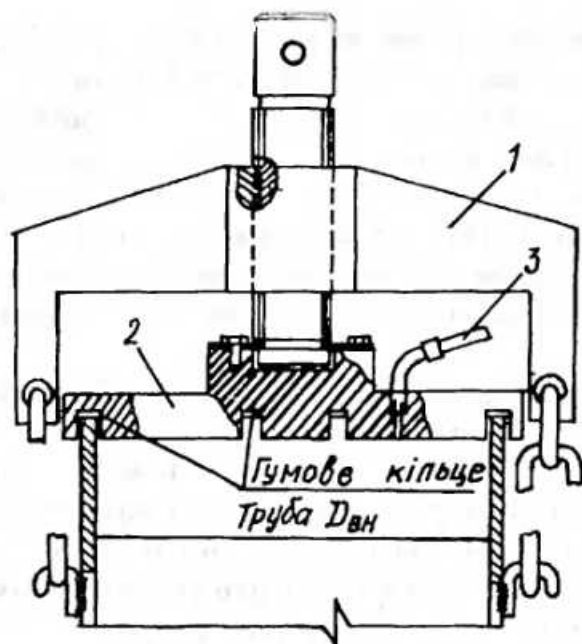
Інвентарна заглушка: 1 - скоба з гвинтом; 2 - змінний фланець з проточками для труб різного діаметра; 3 - штуцер для приєднання компресора (преса)
